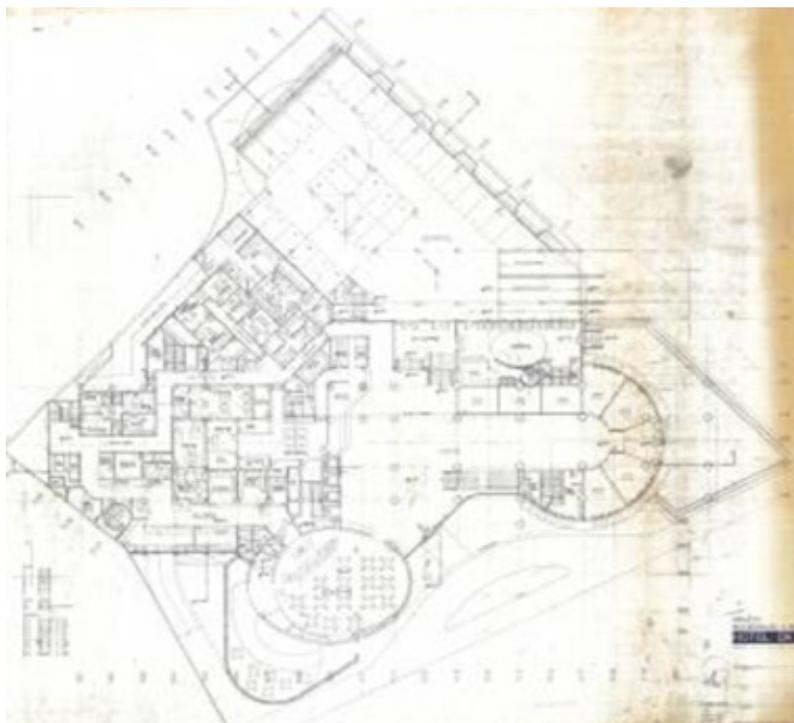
Planta baixa do pavimento térreo após reforma.
